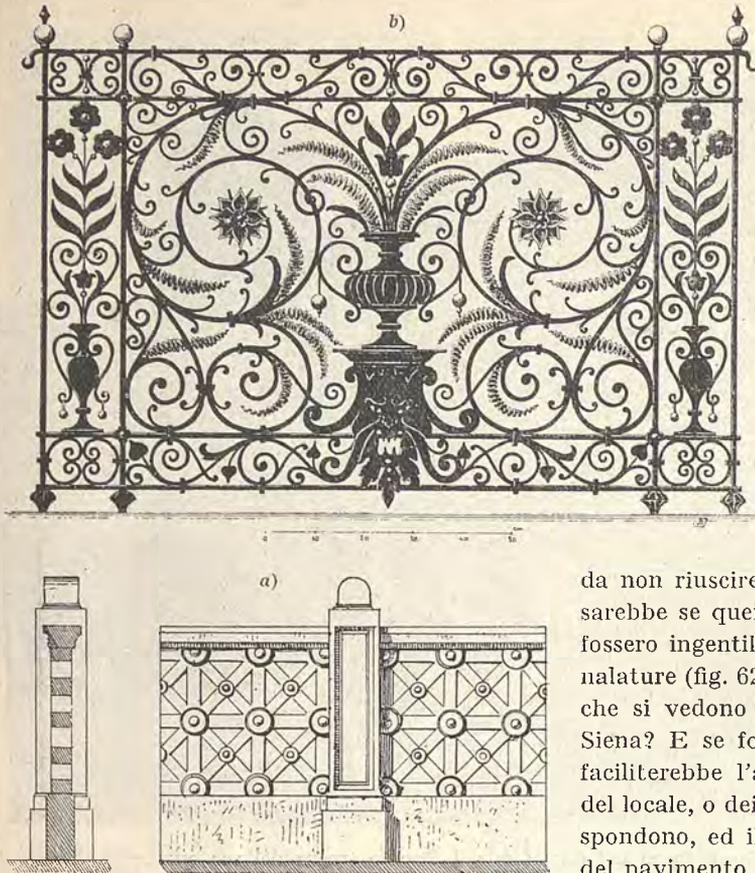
a, b. — Parapetti per poggiuoli e balconate.
